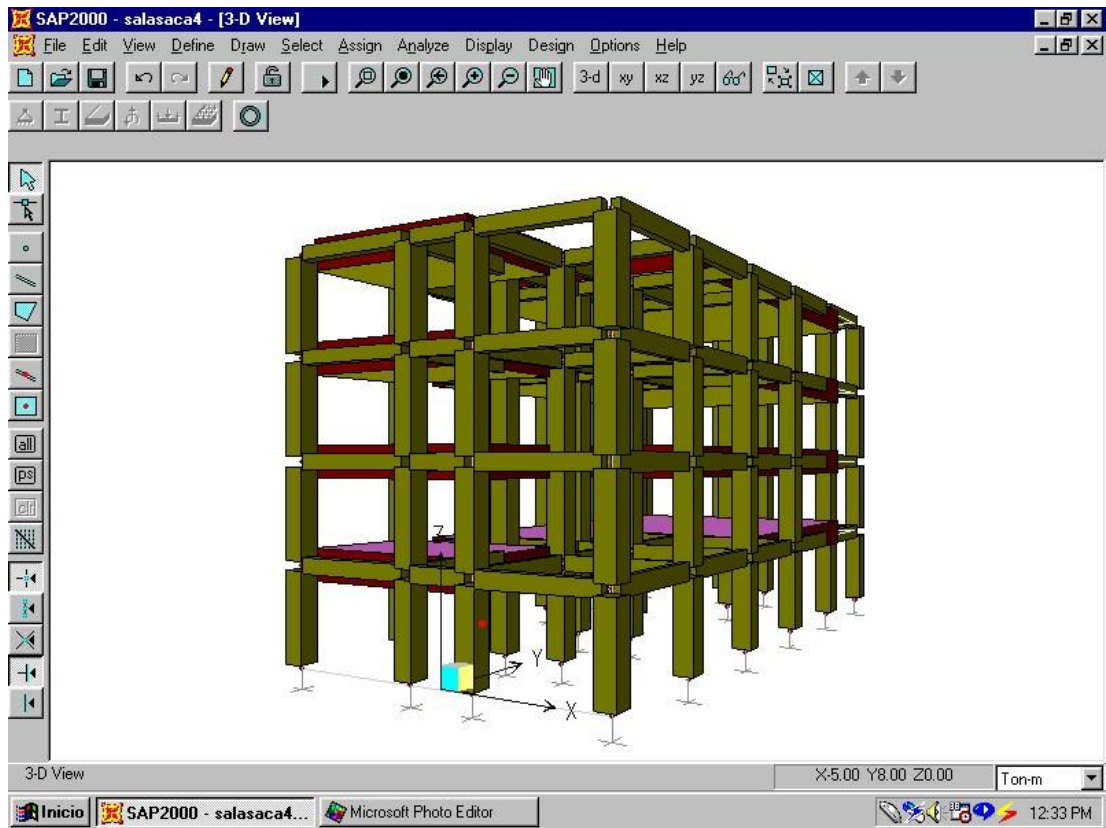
Pórtico espacial. Secciones de vigas, columnas y losas (perspectiva).
